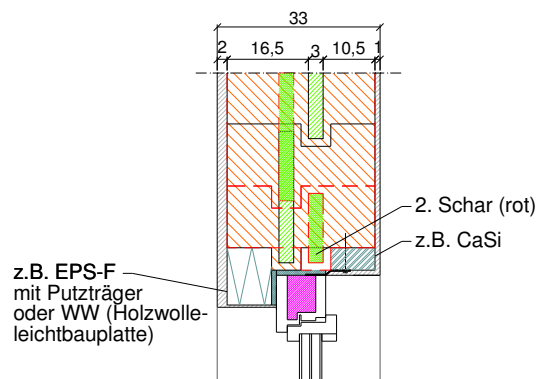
Detail – Fensteranschluss Horizontalschnitt [eigene Abb.]
